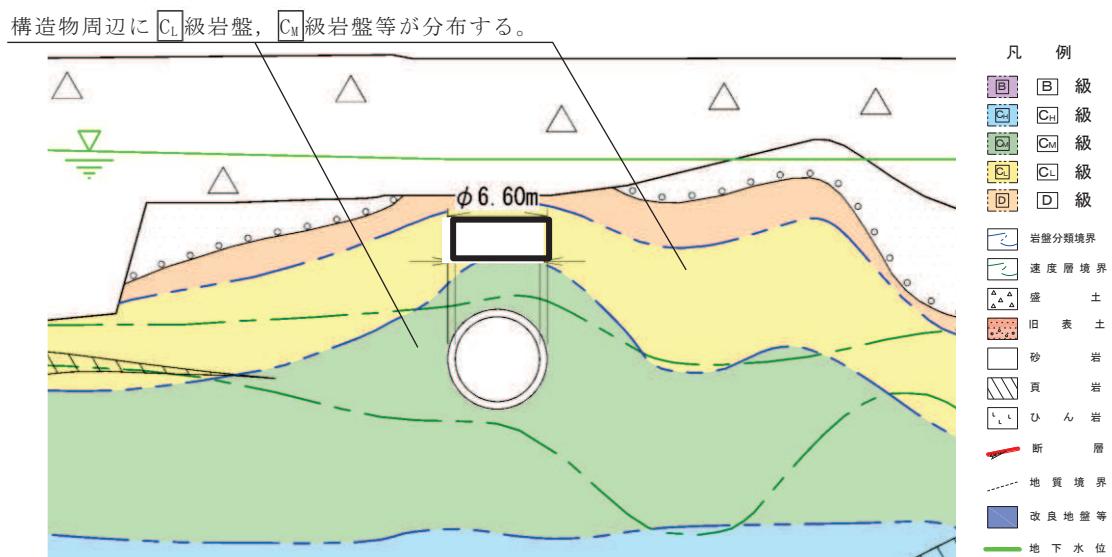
(参考例) パターン 2: 排気筒連絡ダクト (岩盤部) の例
